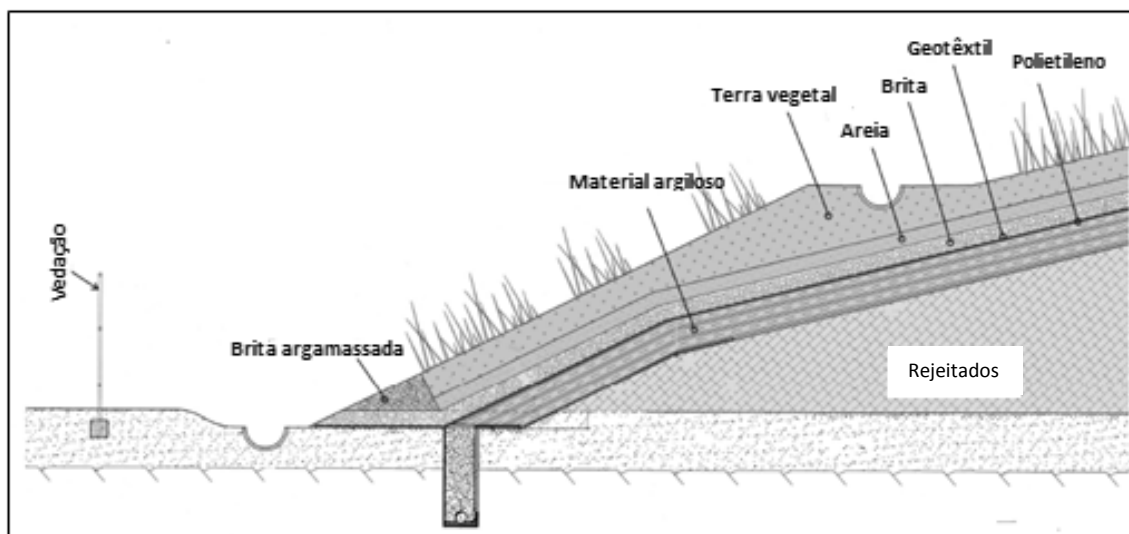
Esboço da impermeabilização da escombreira com a modelação proposta (Adaptado de EXMIN, 2004)
